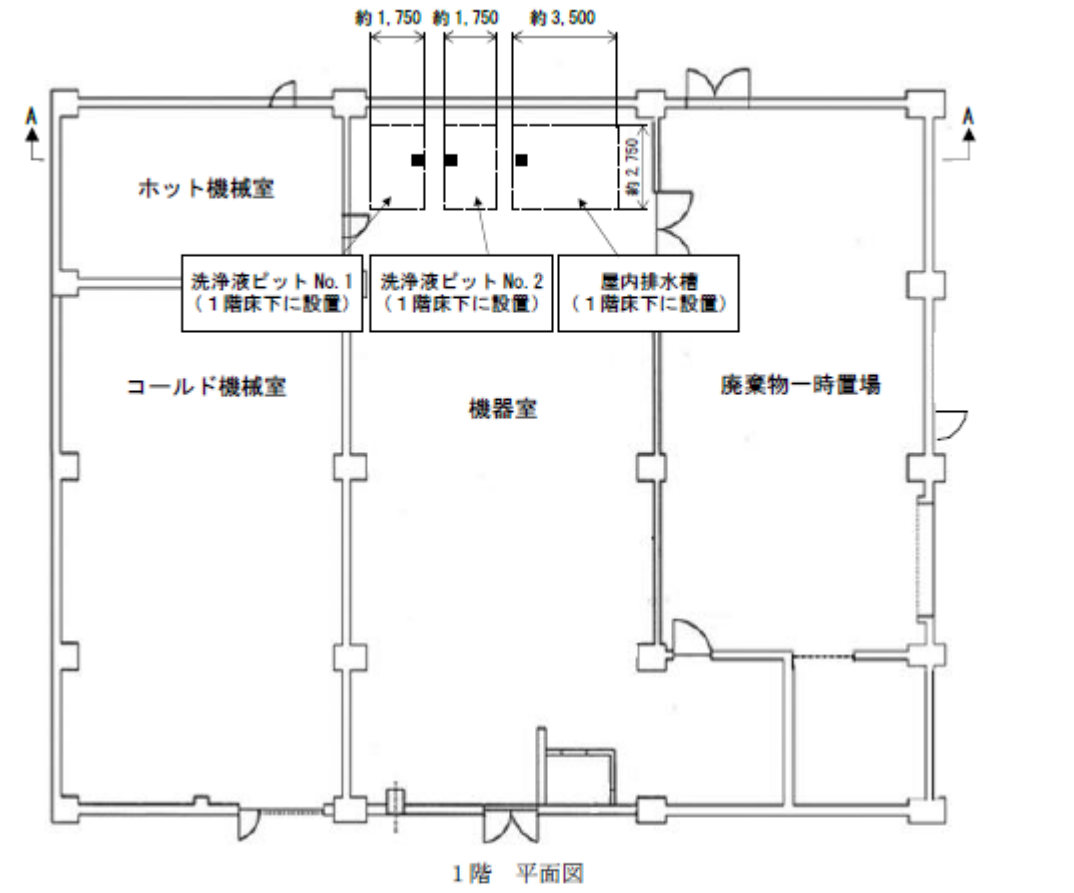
第1廃棄物処理棟の液位計の配置図
